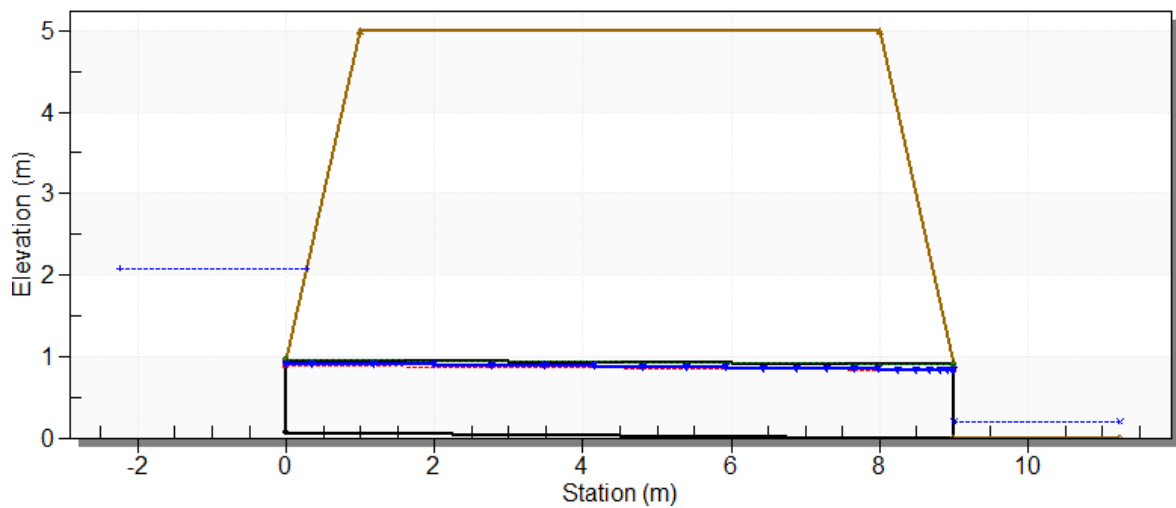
Desing Culvert. Concreto Reforzado 900 mm
